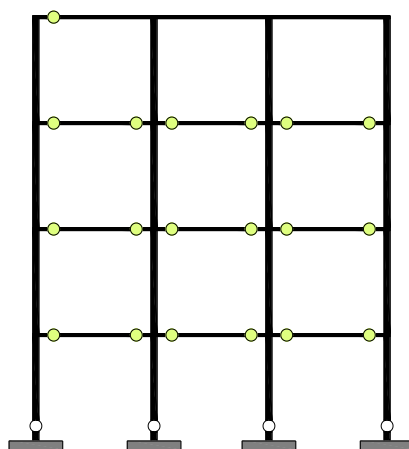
Mecanismos de colapso columna fuerte-viga débil.
